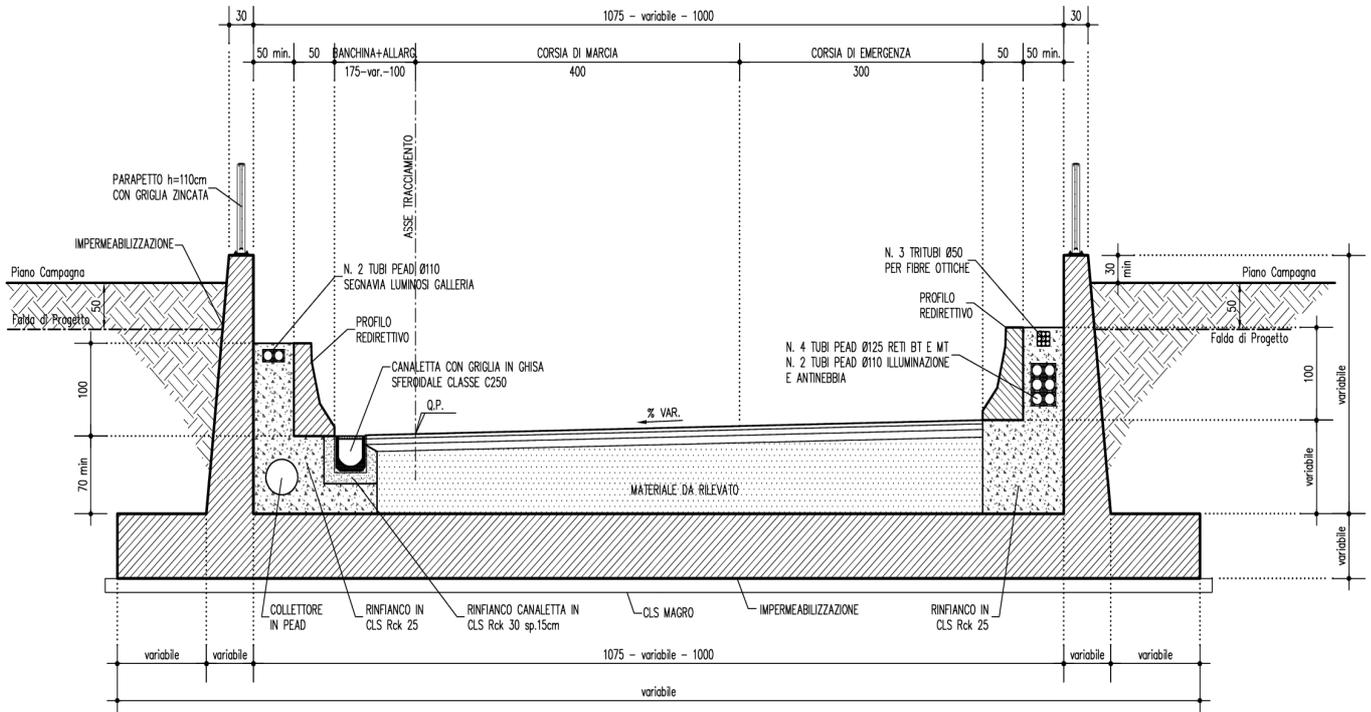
SEZIONE TRASVERSALE TRINCEA DI MURI AD U
